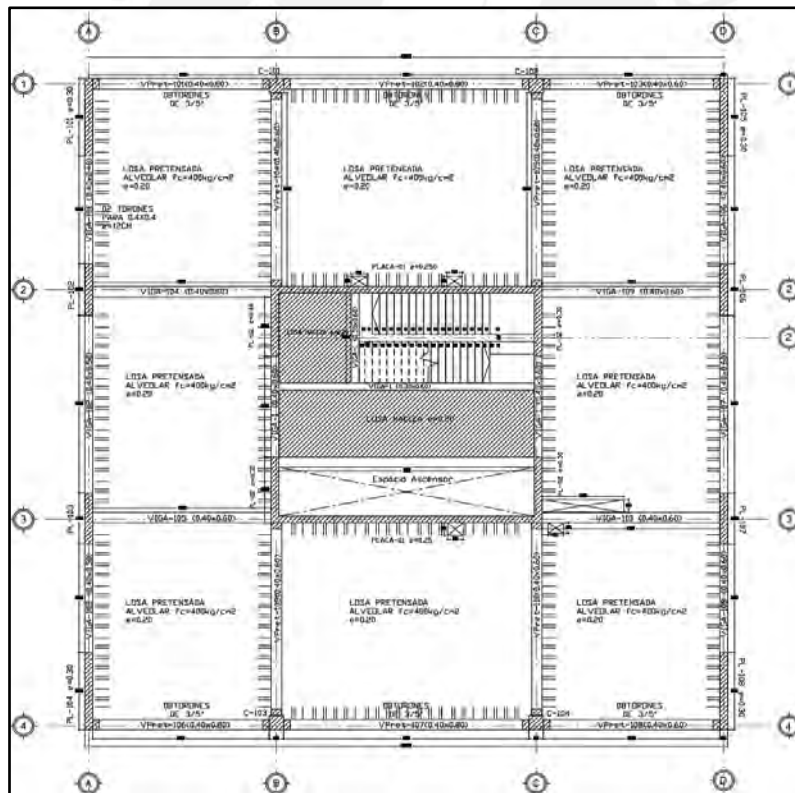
Planta estructural de la edificación (Fuente propia)
